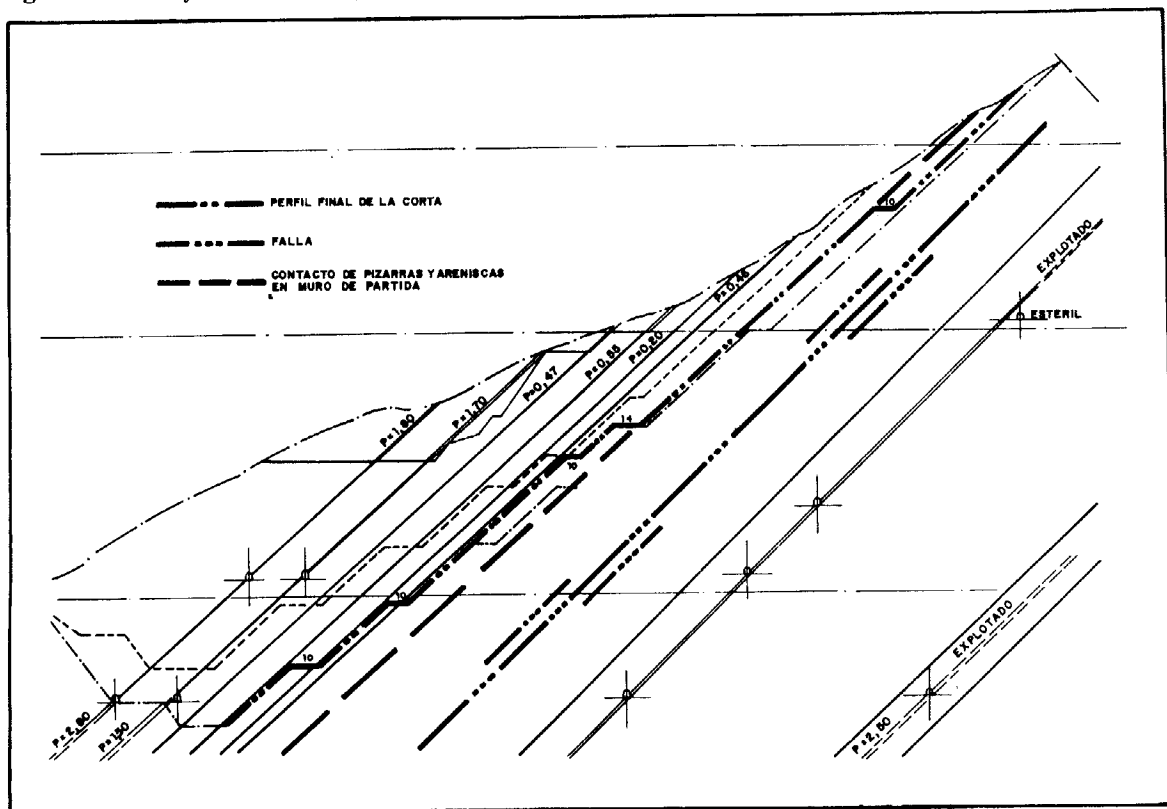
Perfil final de la corta (E-14) (Pizarras muro partida 24 m de potencia horizontal).
